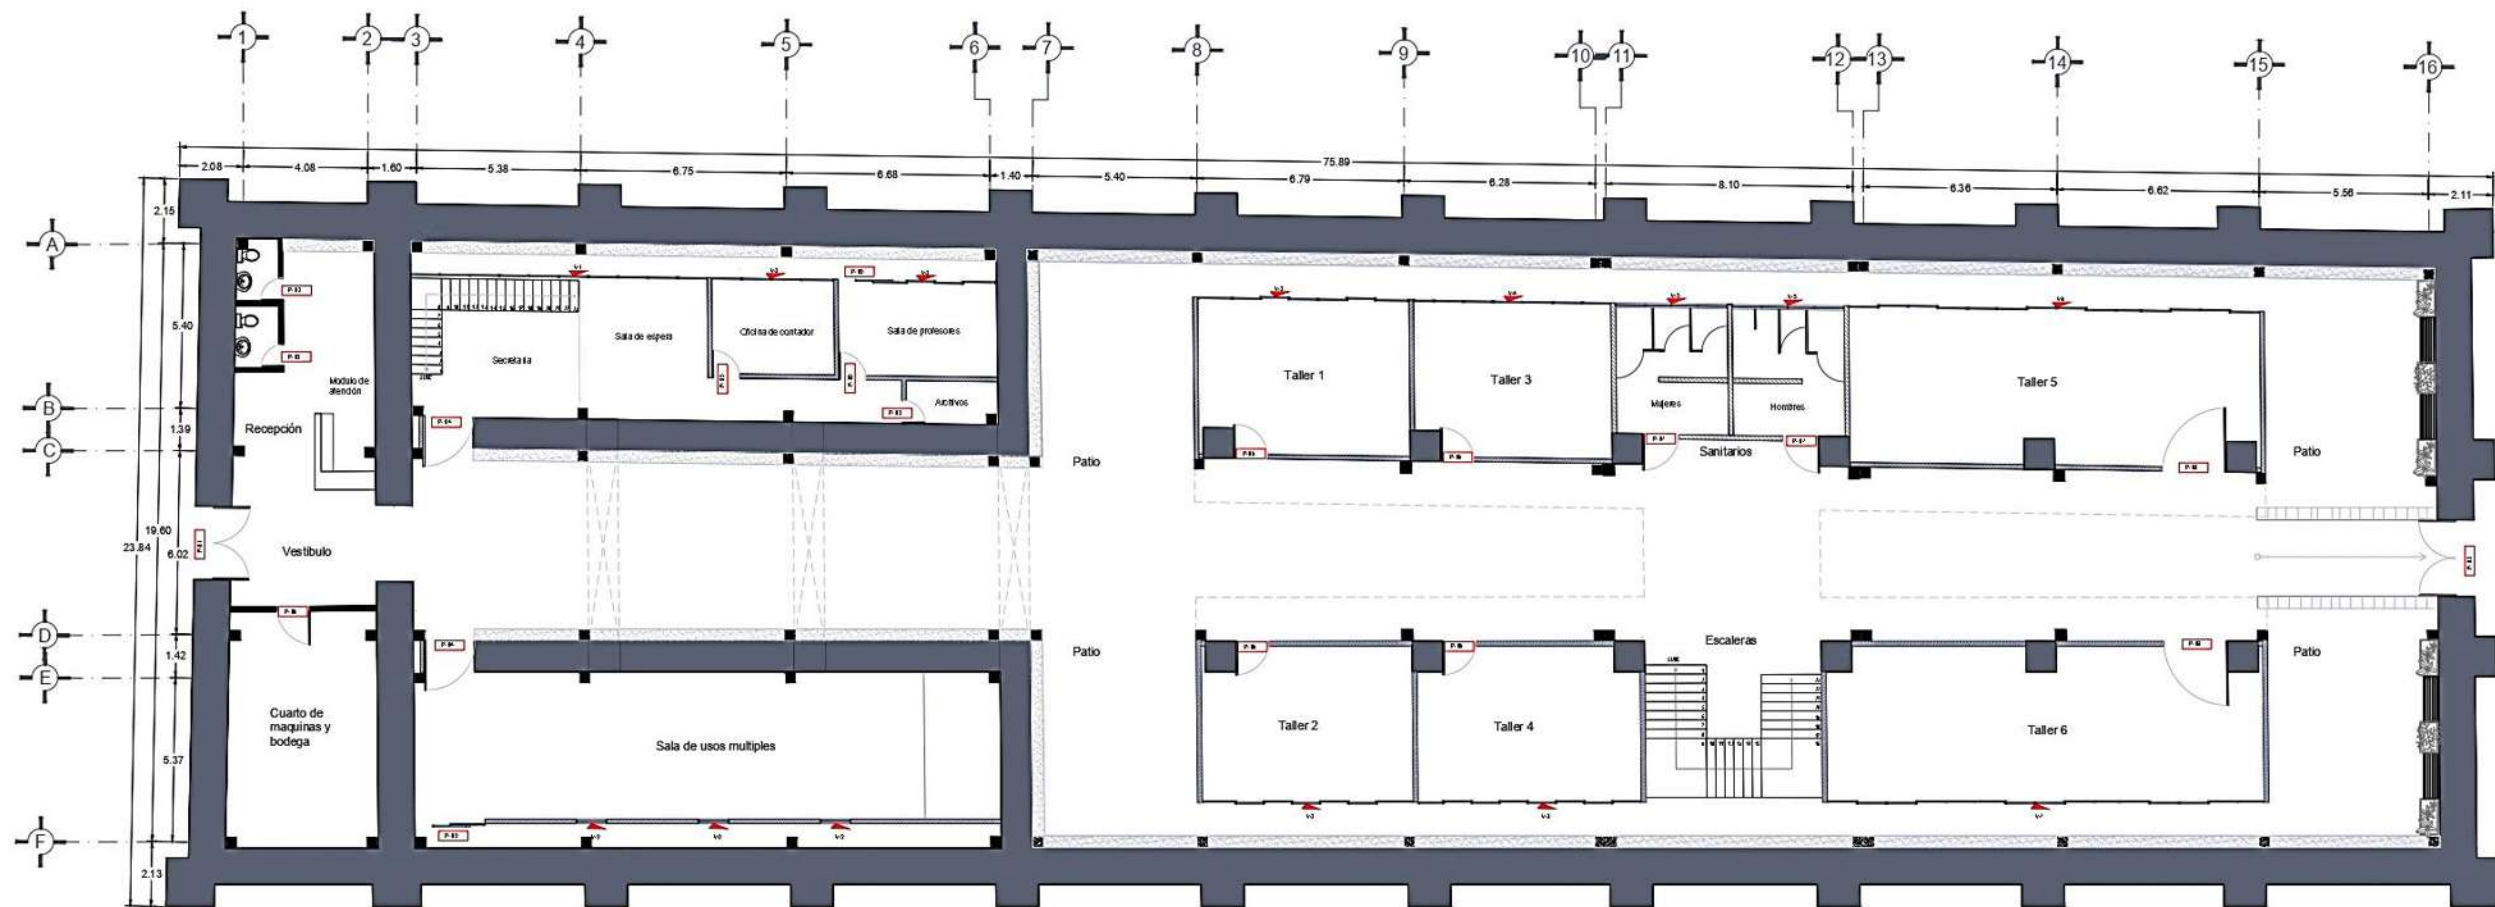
Planos de albañilería 4. Fuente: Elaboración propia.
